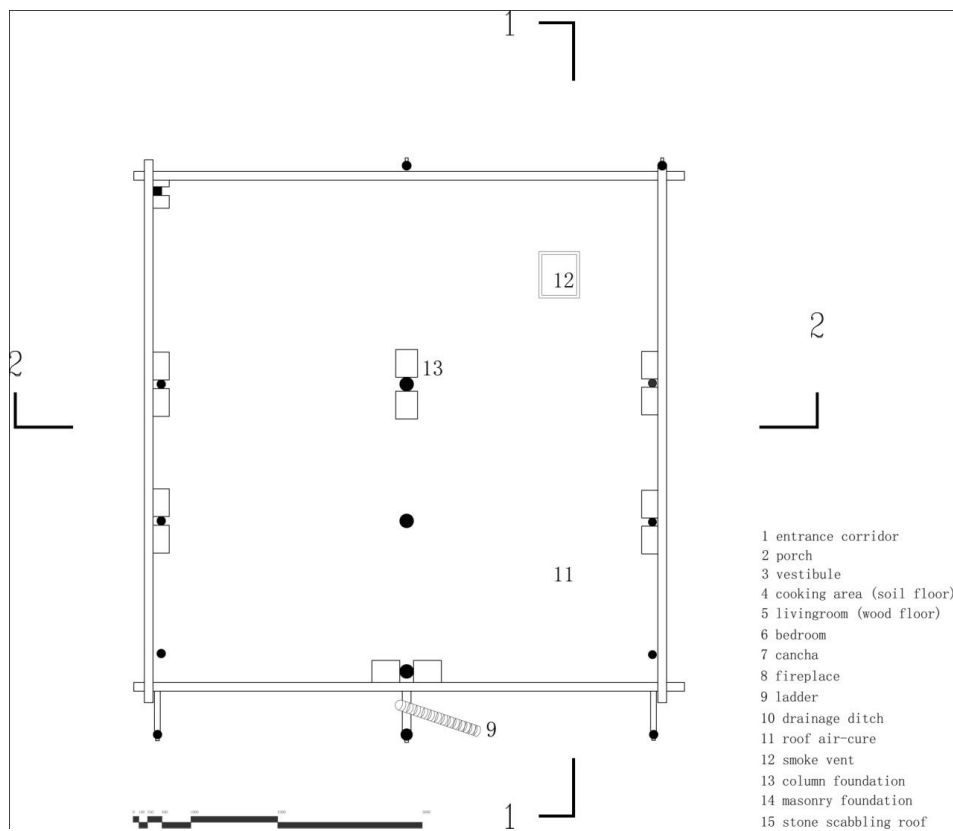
秋那桶村嘎干堂组何宅正屋屋顶晒场平面图
